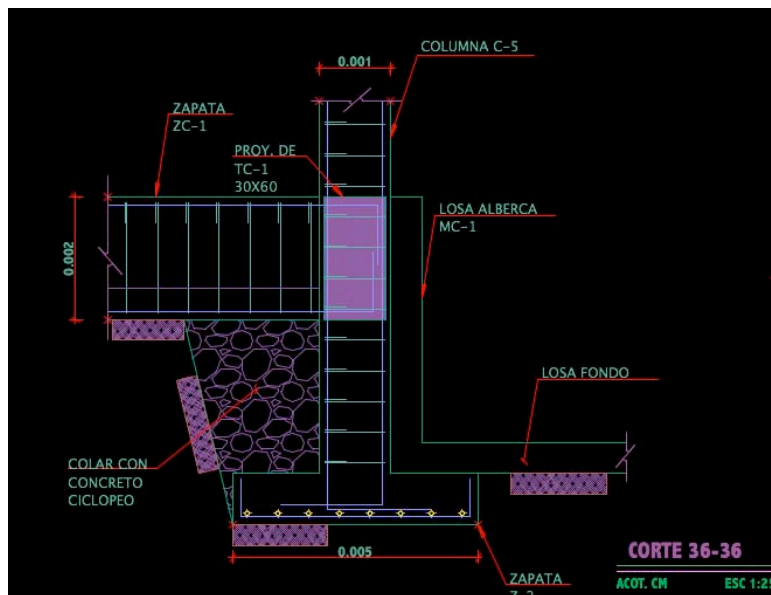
Detalle de cimentación de alberca e intersección entre zapatas corridas e aisladas
